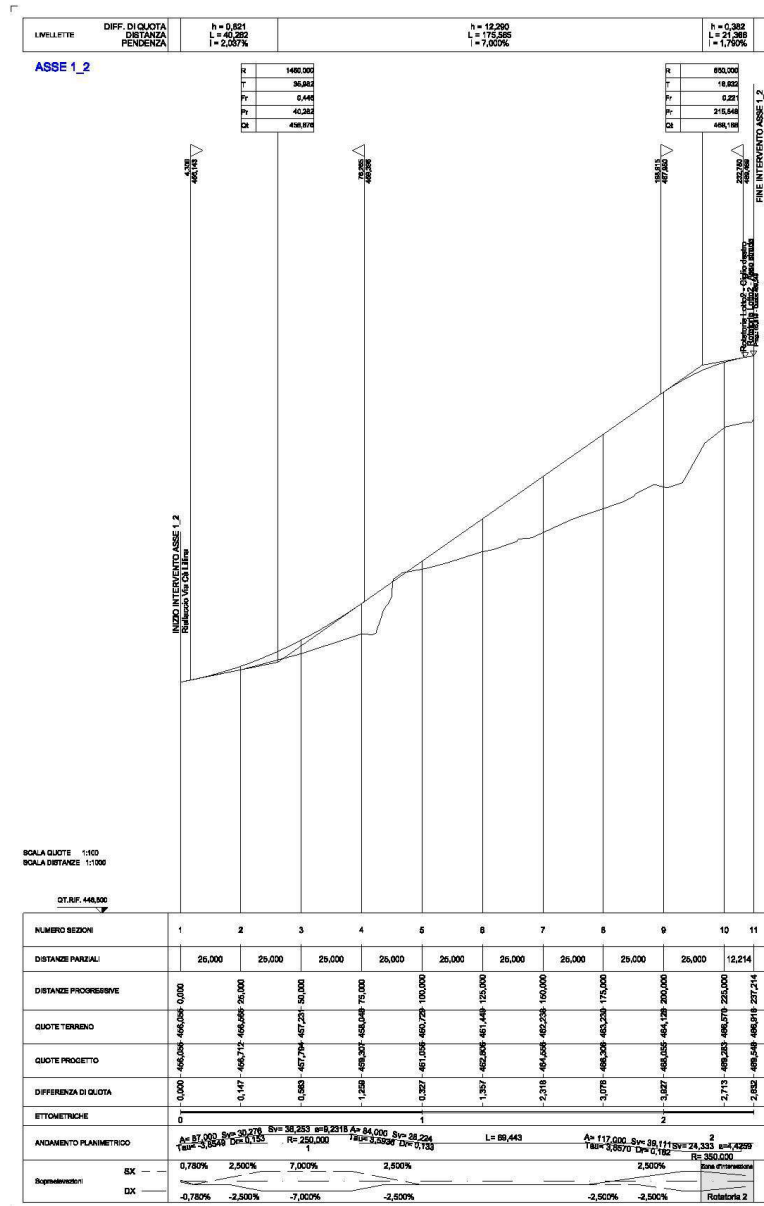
Profilo longitudinale dell'Asse 1\_2.
